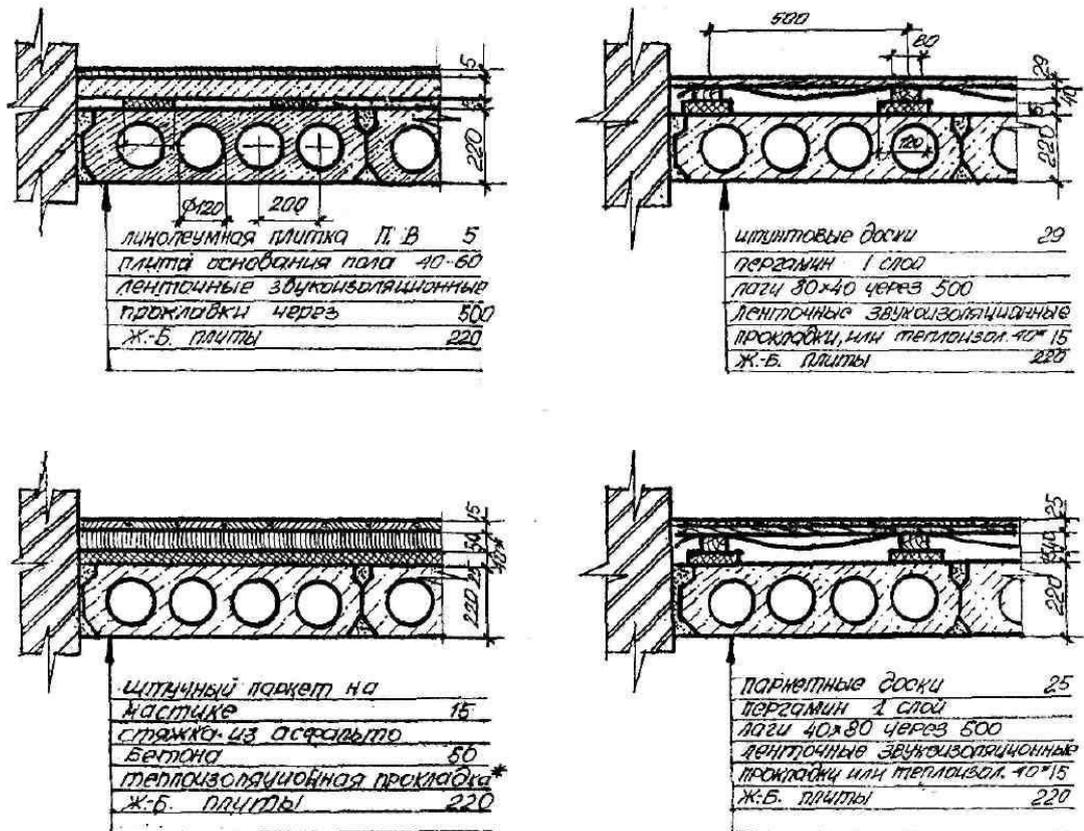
Полы по железобетонному междуэтажному перекрытию.
